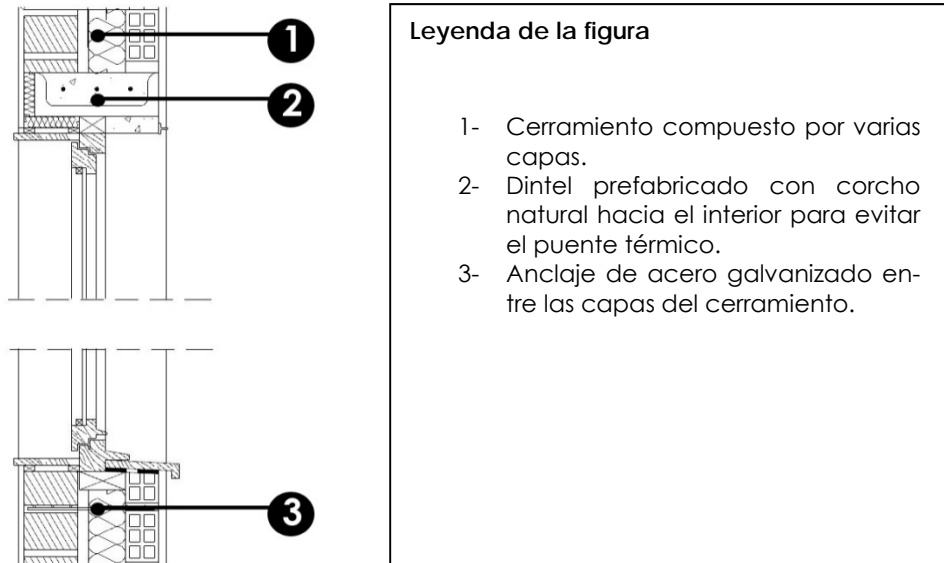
Fachada Norte. Hueco. BAR-002. Fuente: Gabriel Barbetá – David Pradas Ruiz. Elaboración propia.
